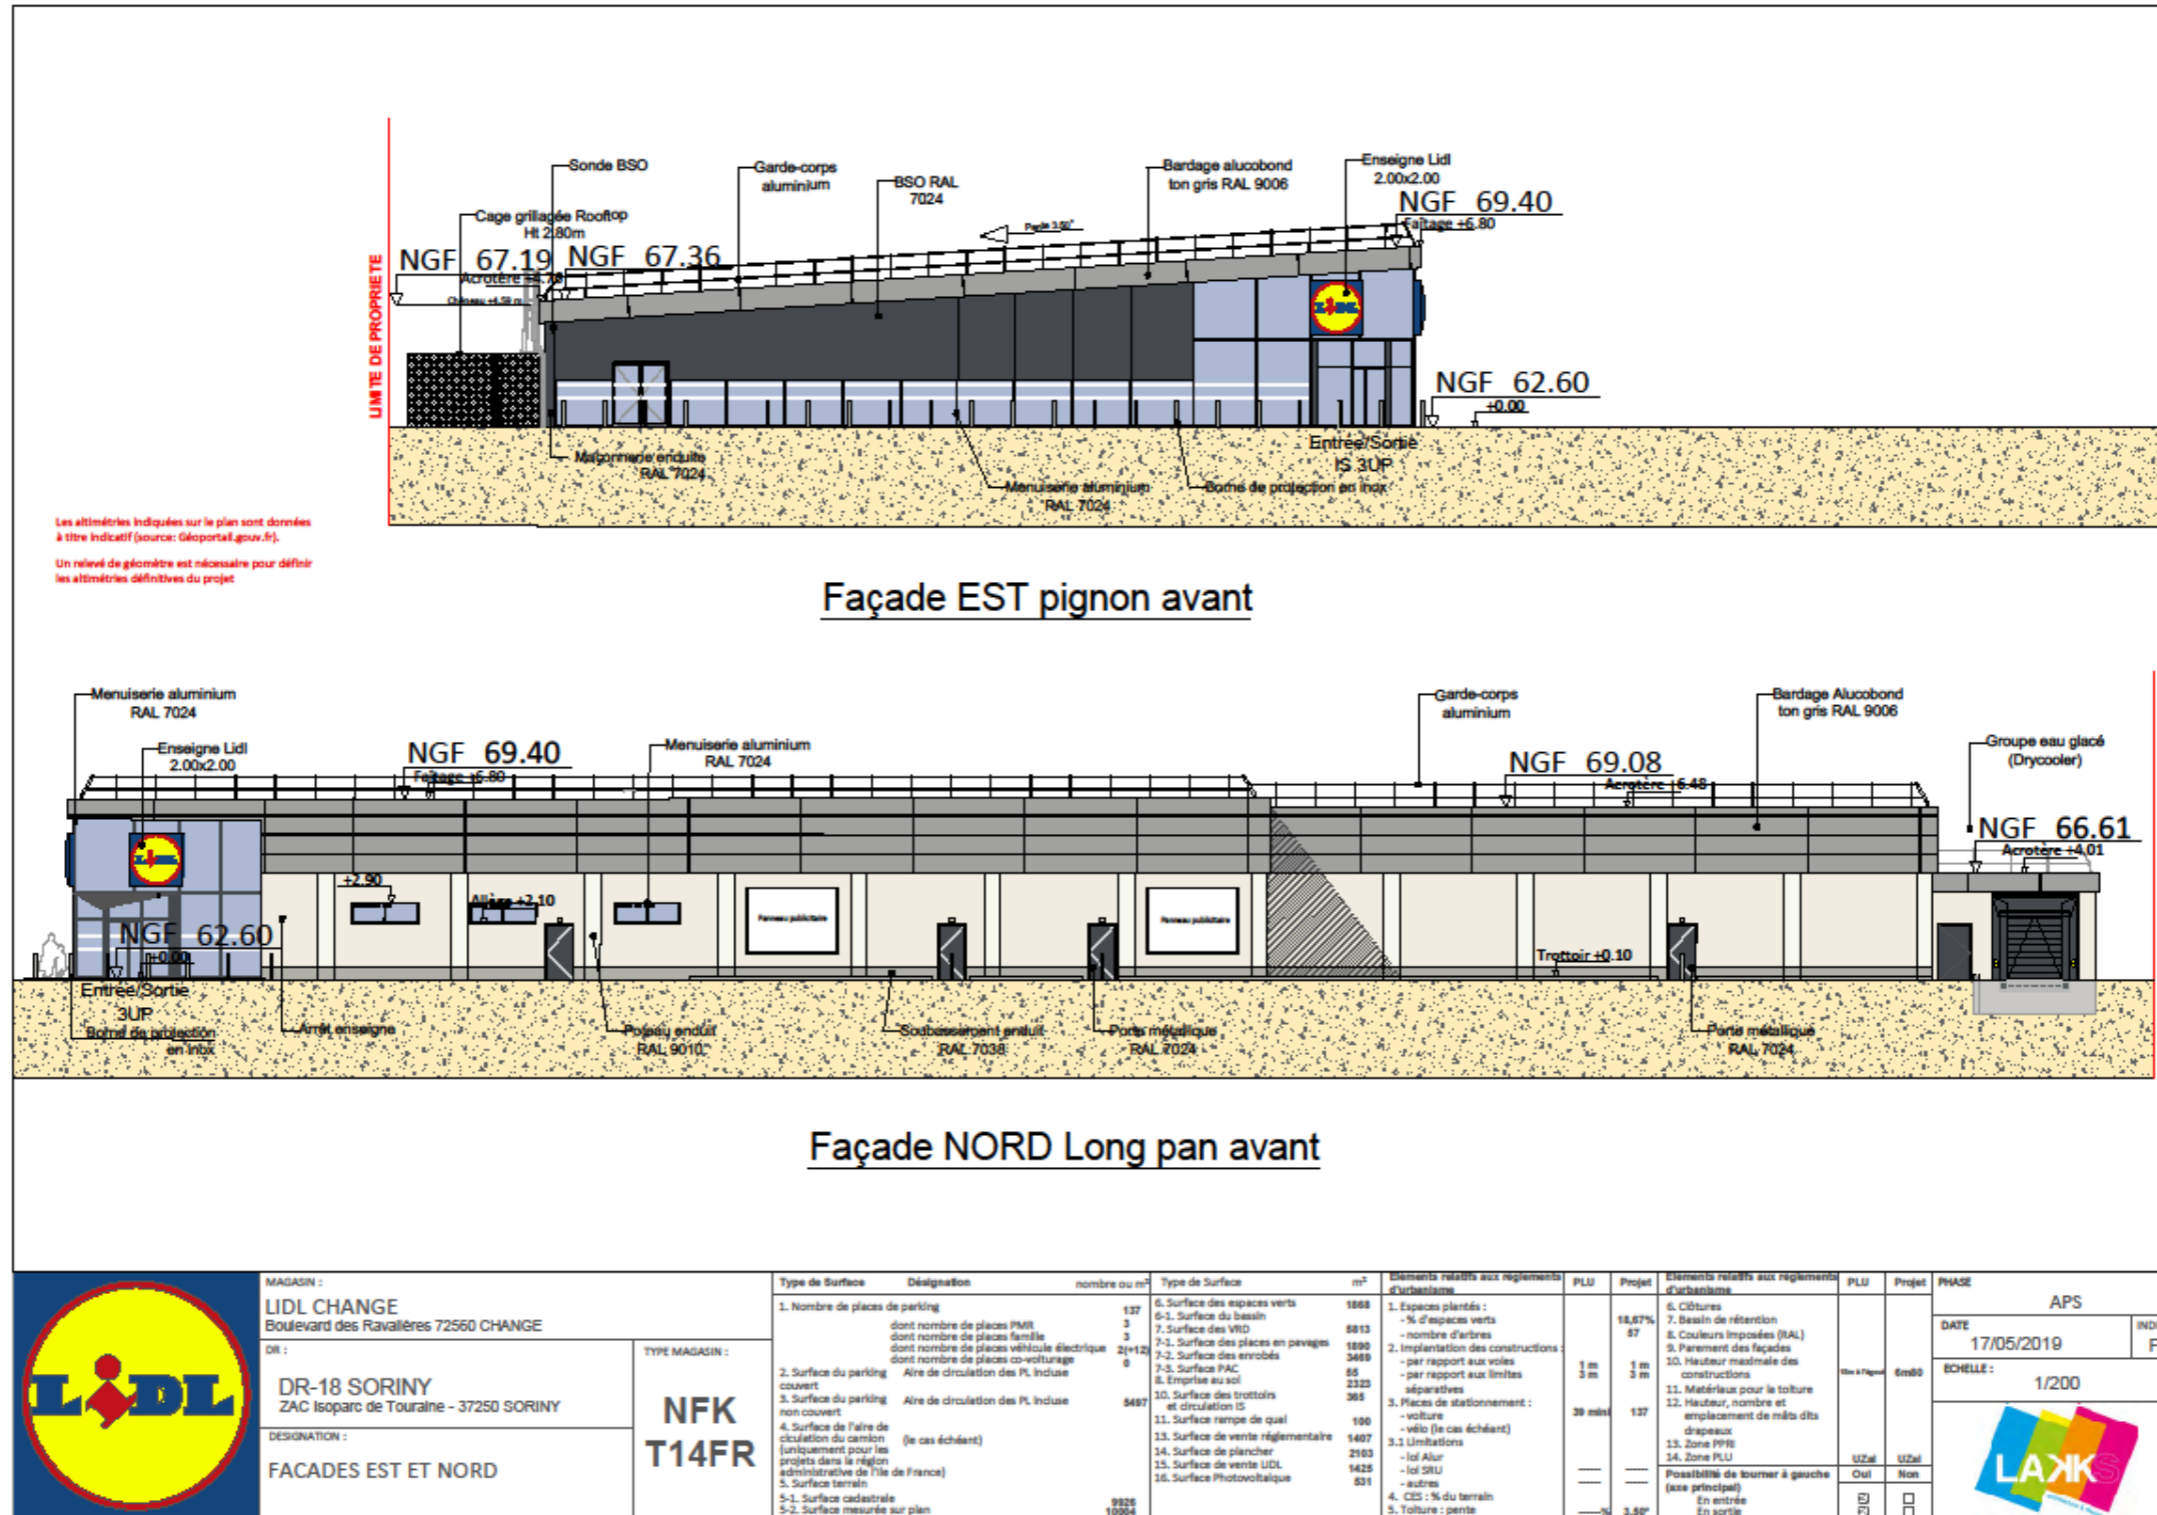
Plan des façades est et nord du projet de surface commerciale LIDL à Changé
